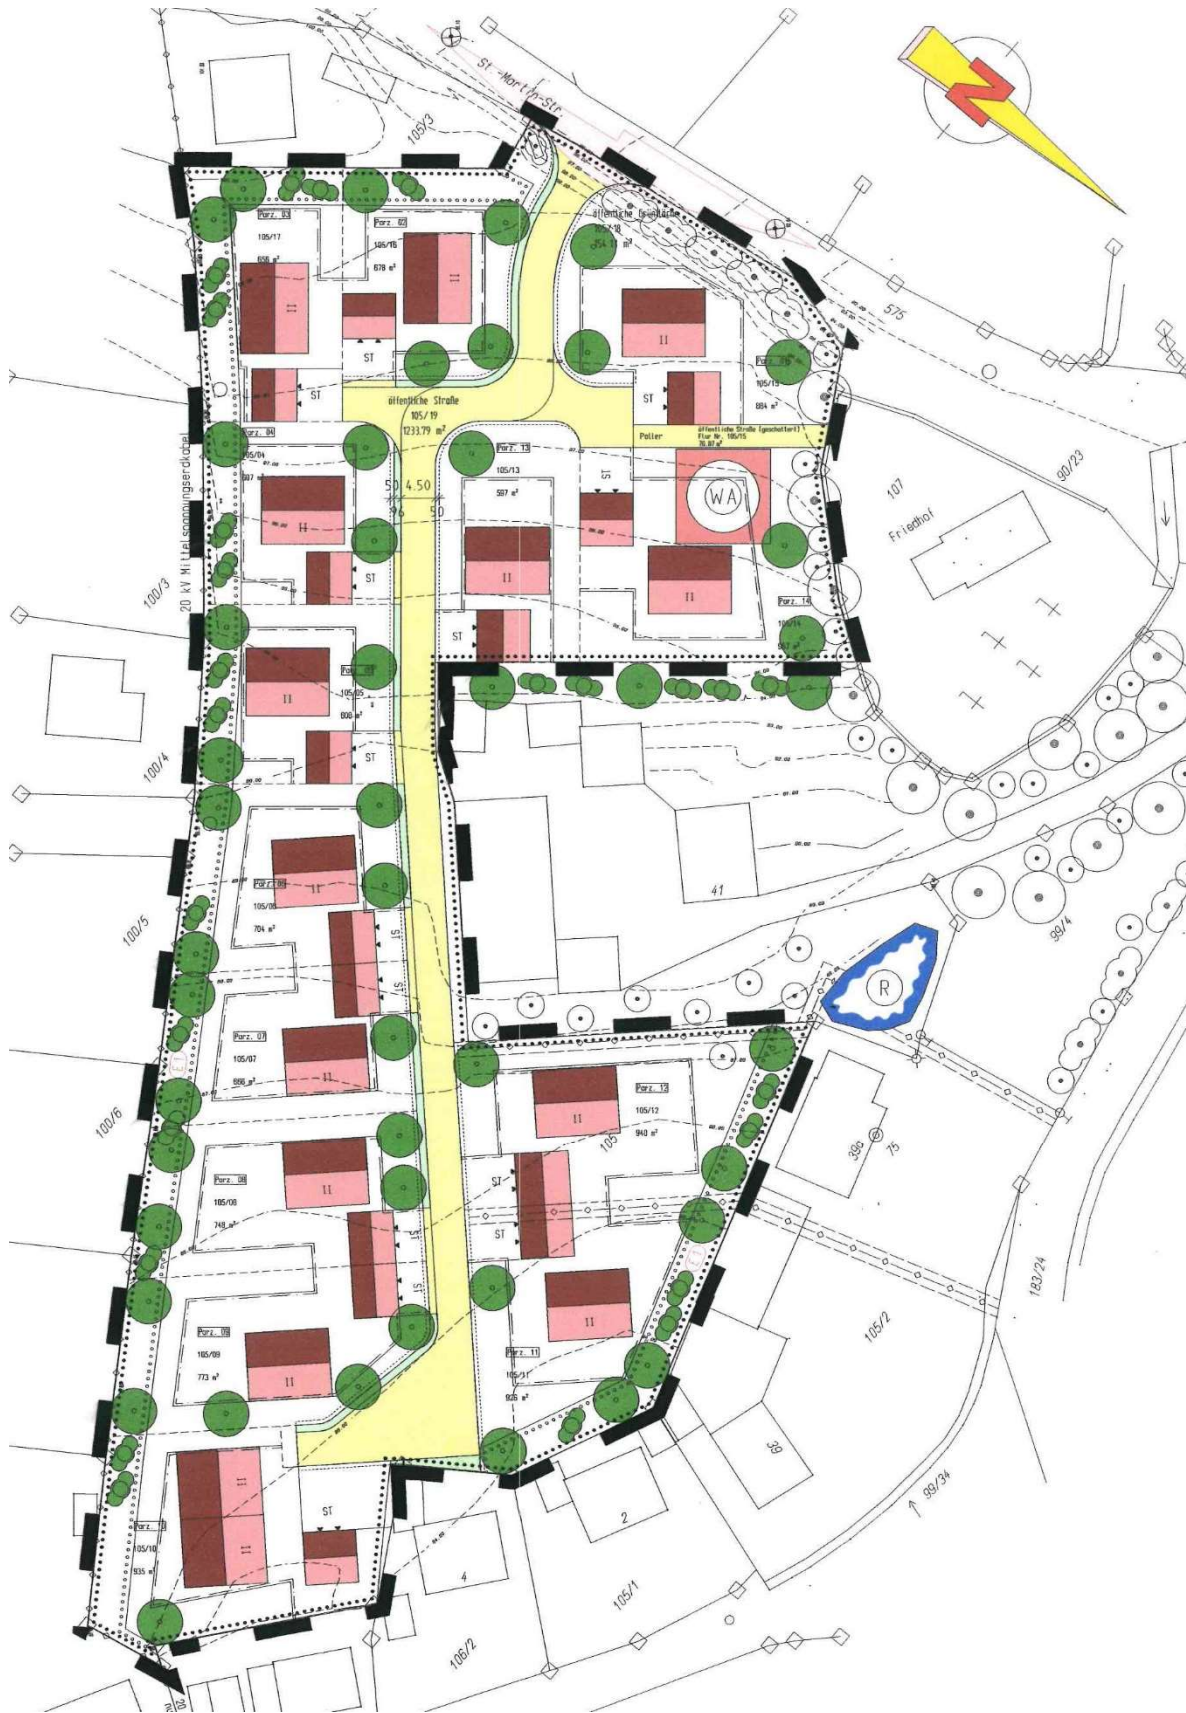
Ausschnitt rechtsgültiger Bebauungsplan
